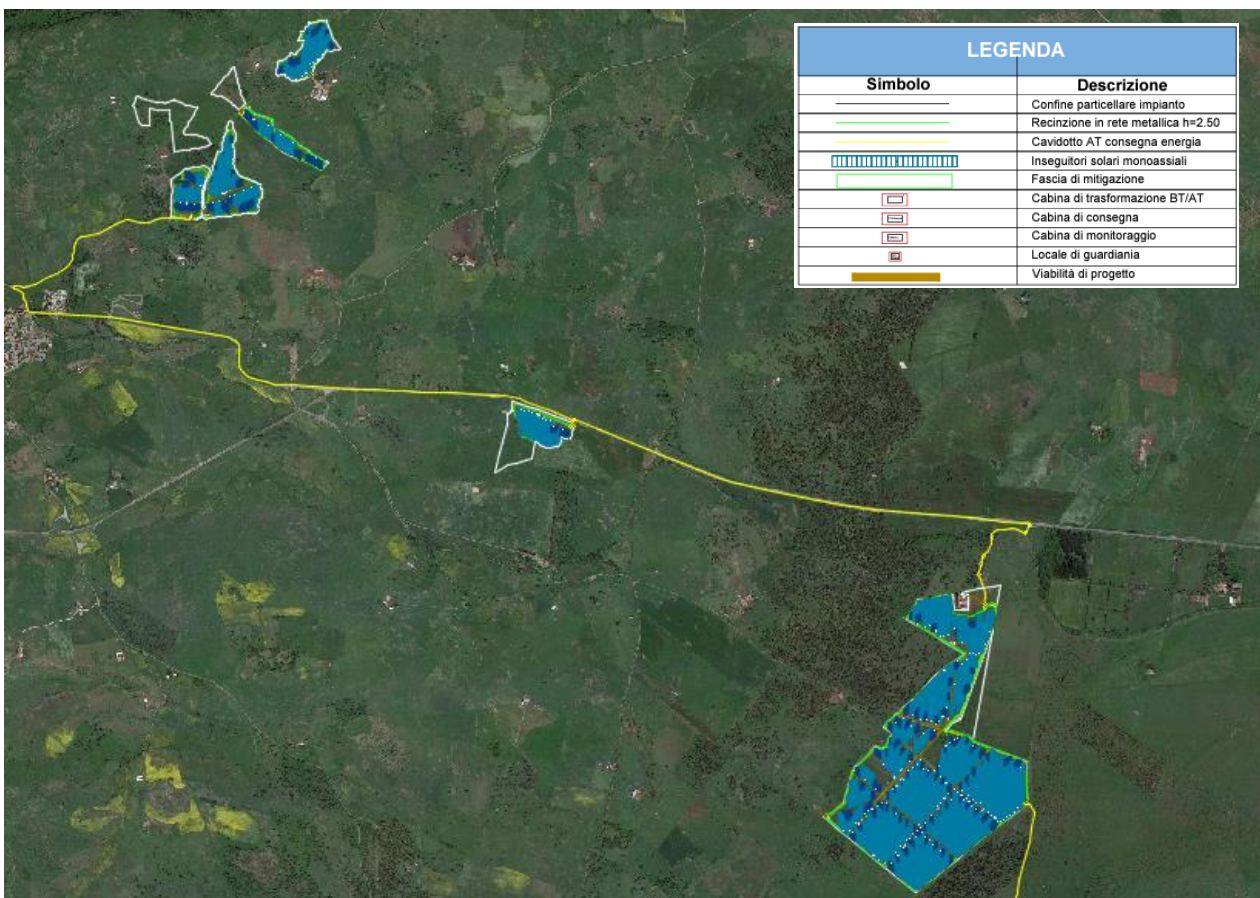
LAYOUT PLANIMETRICO DELL'AREA DI IMPIANTO
